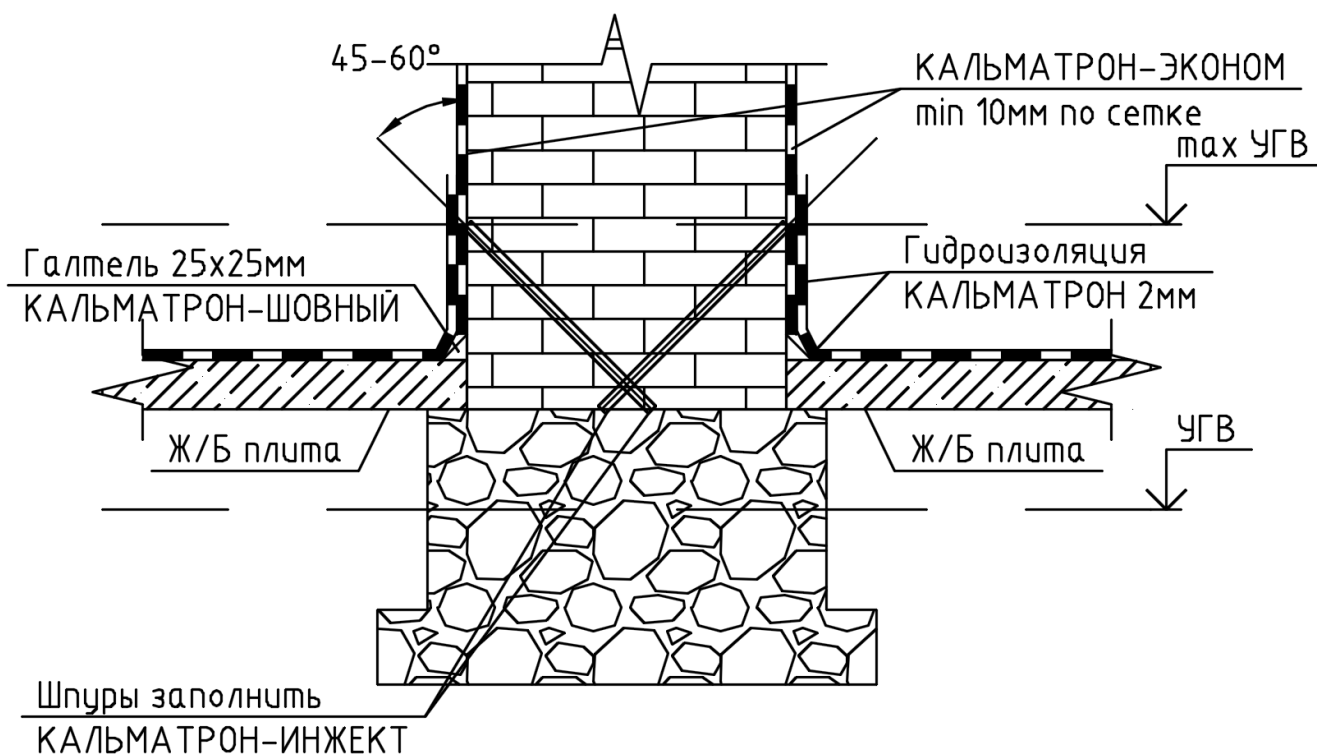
Устройство отсечной гидроизоляции Вариант №2
